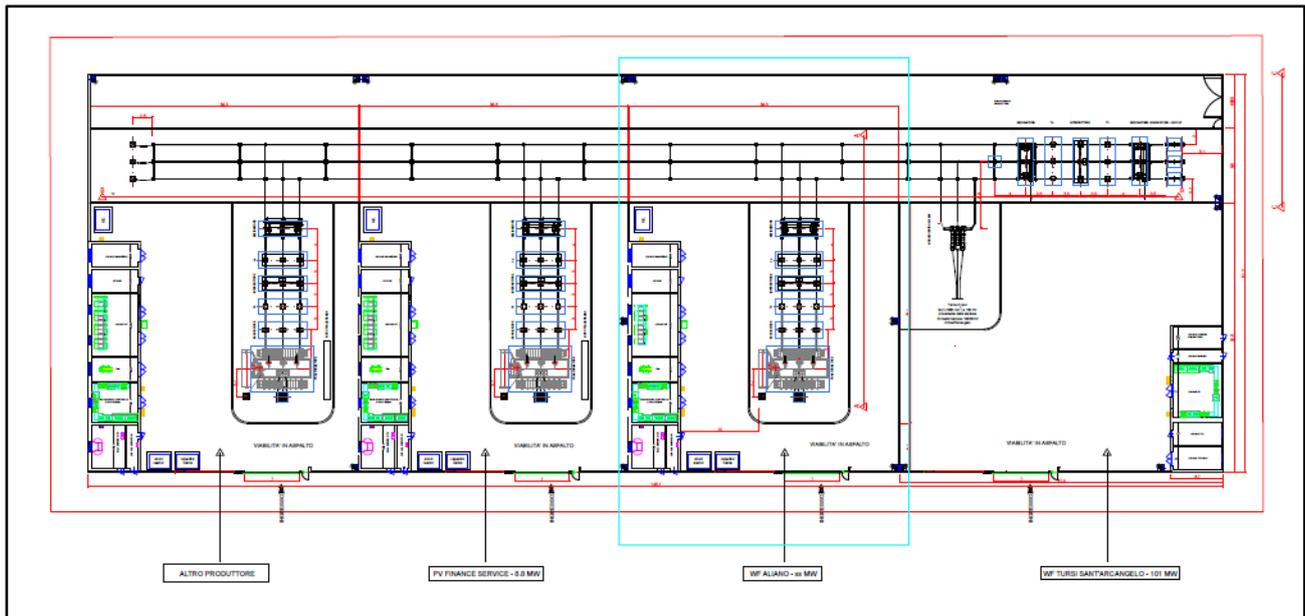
Planimetria elettromeccanica della Sottostazione elettrica condivisa
